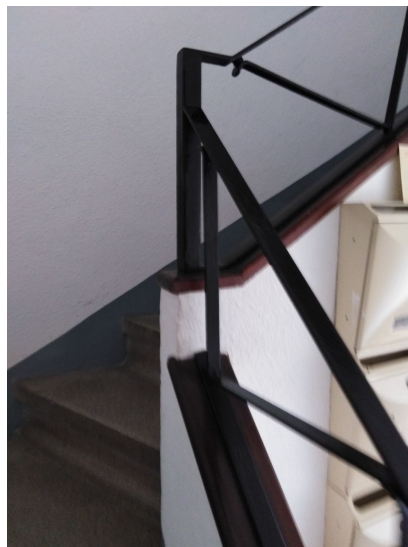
Barandilla de la escalera (Fuente: Elaboración propia)
